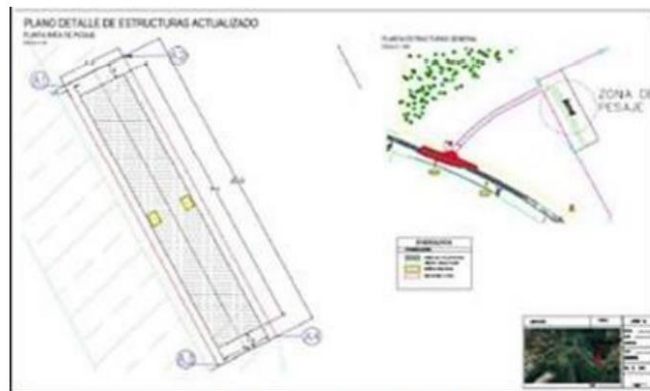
, de la Adenda. Plano detalle de lugar donde será instalado el sistema de pesaje.
